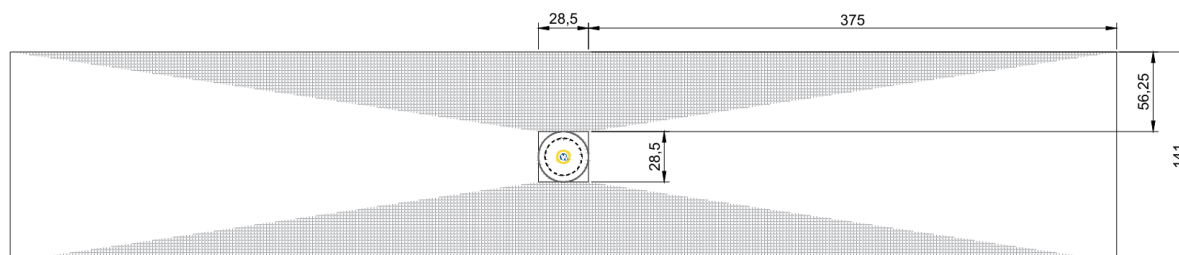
Superficie de transición del vertipuerto en planta (metros).
